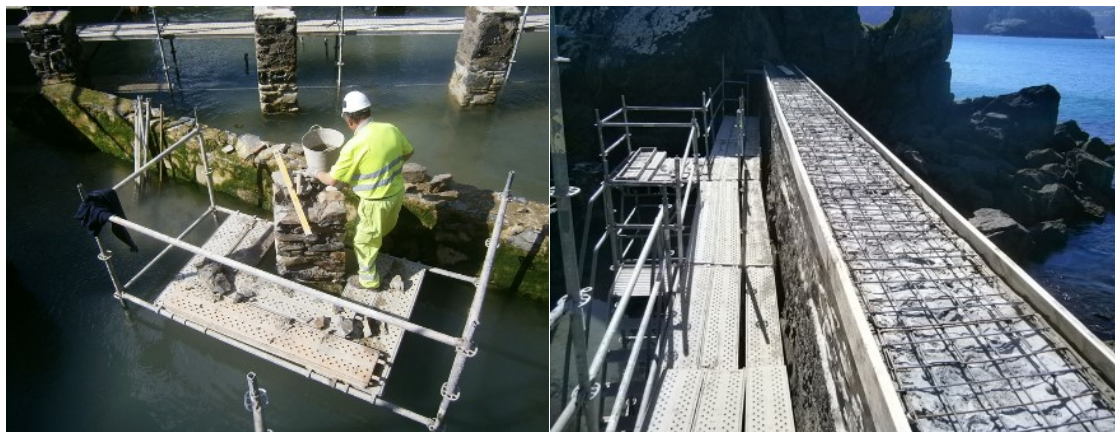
Reparación estructural de pilares y muro perimetral. Fuente: MITECO (2022)
